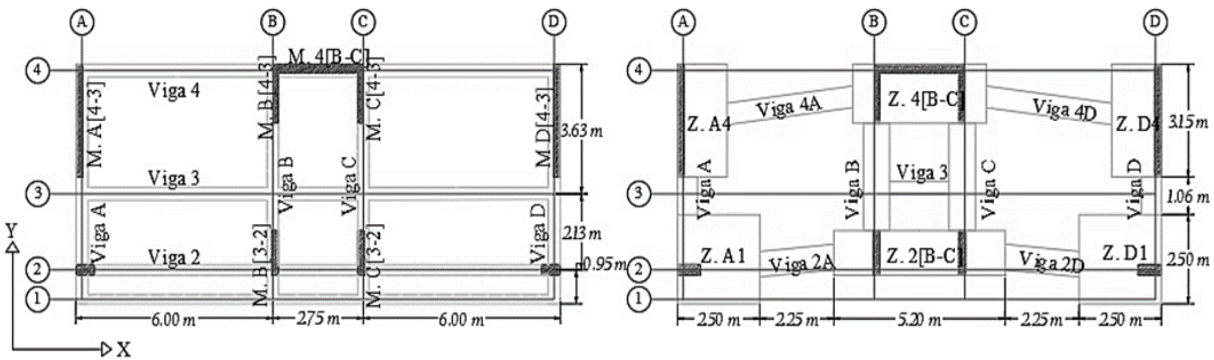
Plantas de la: a.) superestructura, b.) subestructura
